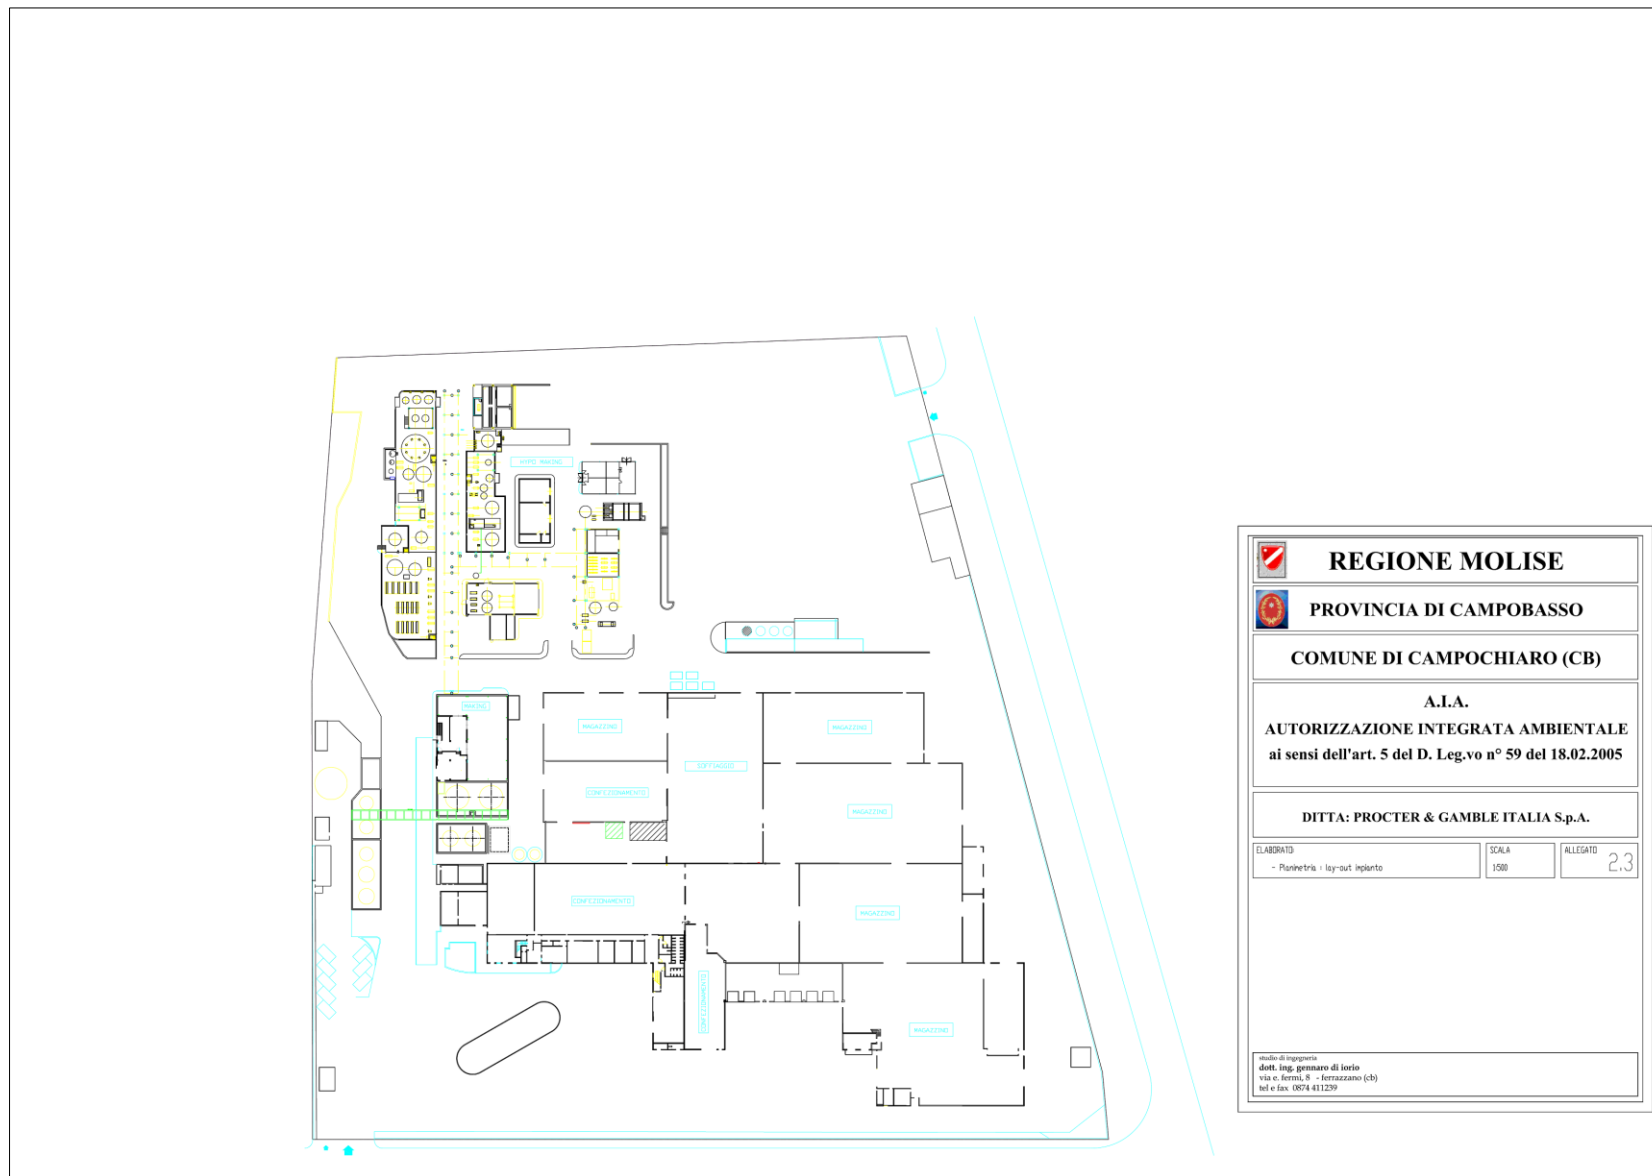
planimetria generale dell'impianto: assetto "ante operam"
